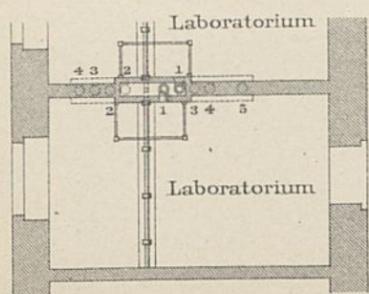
Grundriss, Sockelgeschoss.
